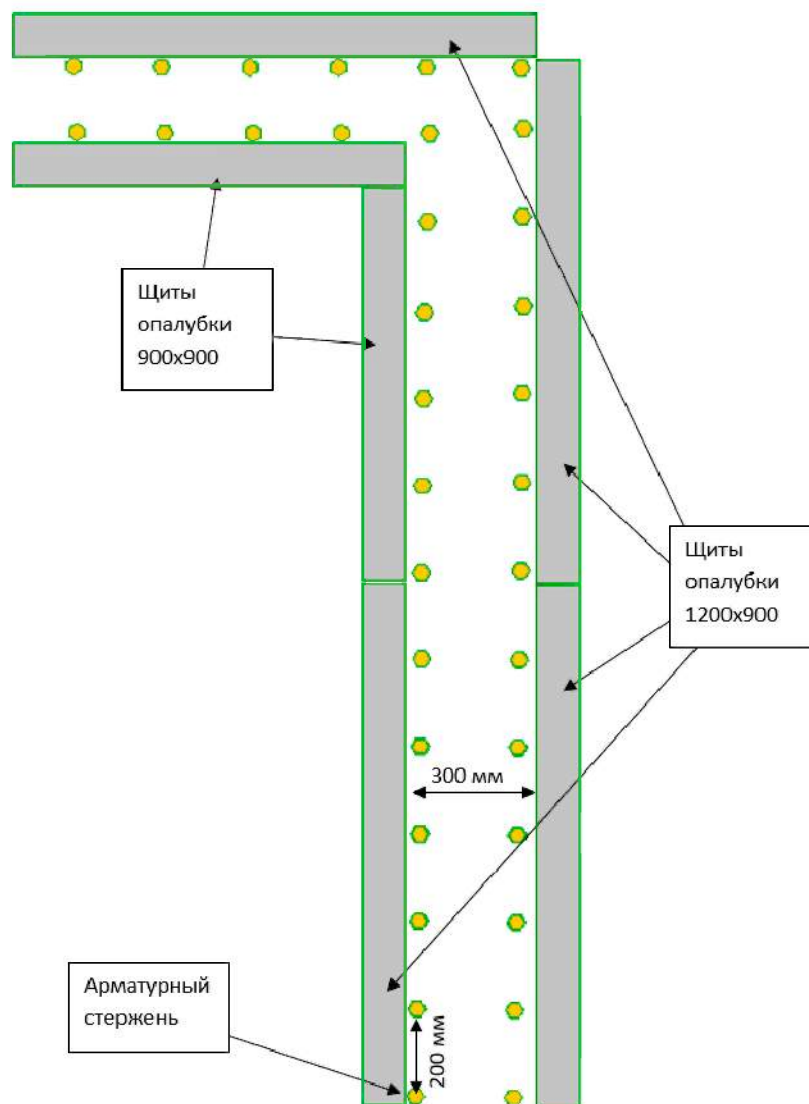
Размещение арматурных стержней внутри опалубки
